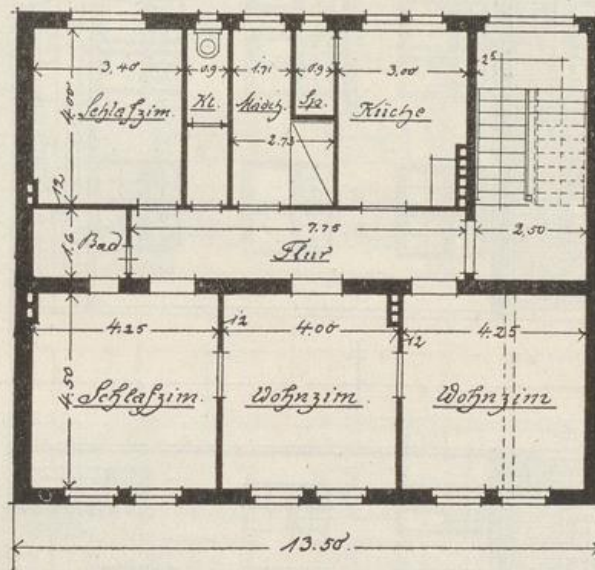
Grundriß eines eingebauten Mietshauses, bildet die Grundlage zu den Abb. 119 bis 134 und 146 und 147.
